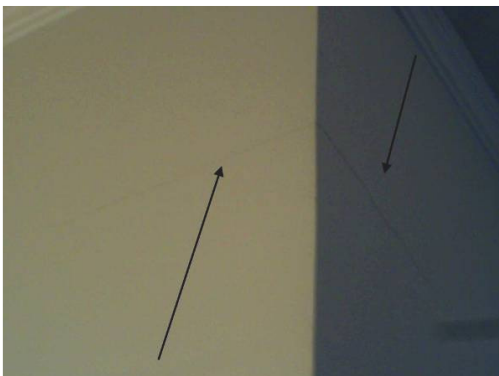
Fissuras horizontais nos pav. intermediários.
